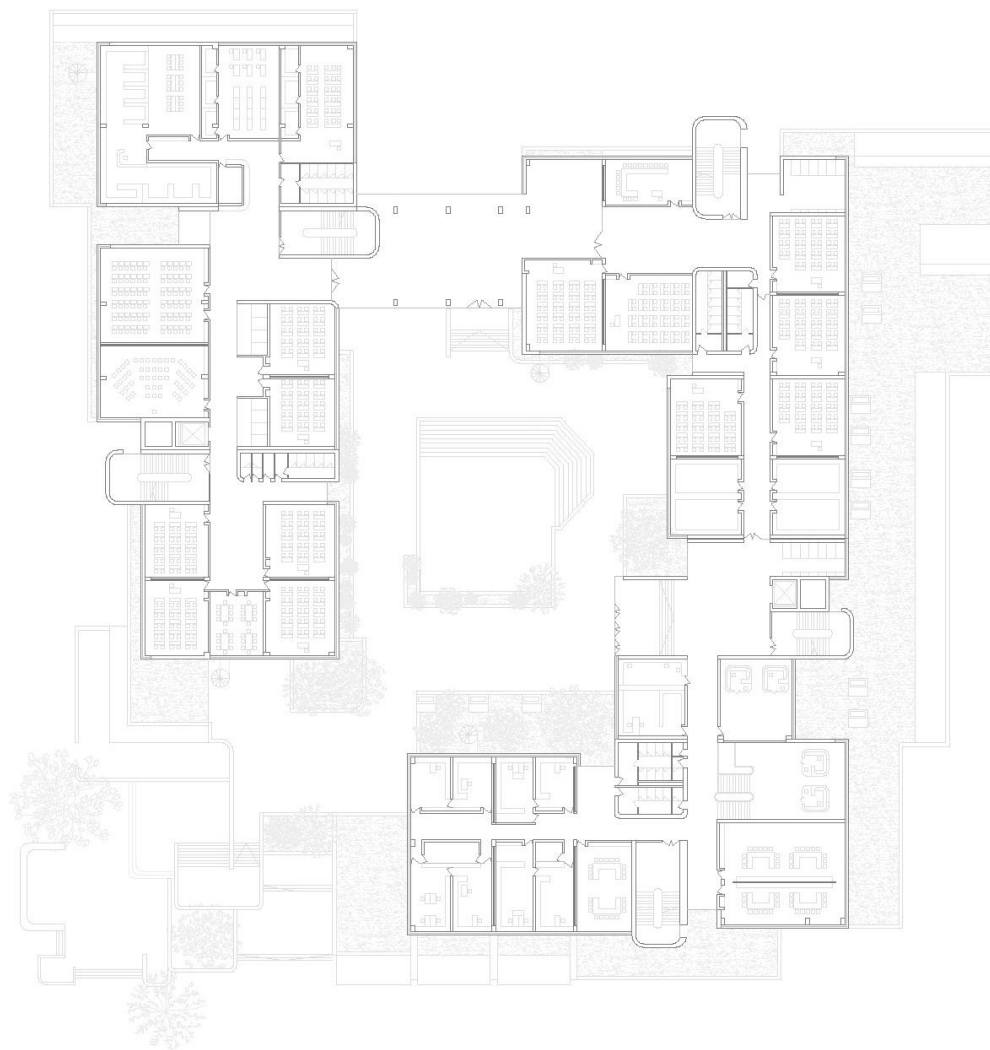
Abb. C: Grundriss 1.OG, Planungsstand Genehmigungsplanung 1972 (Eigene Grafik nach Eingabeplanung LBK)
